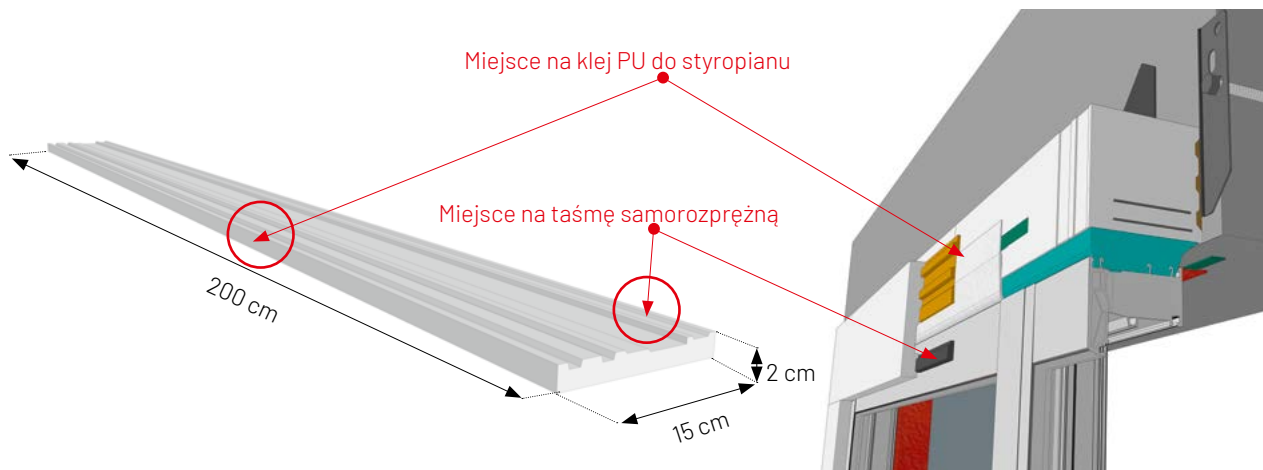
Podstawa Parapetu Wewnętrznego (PPW)
